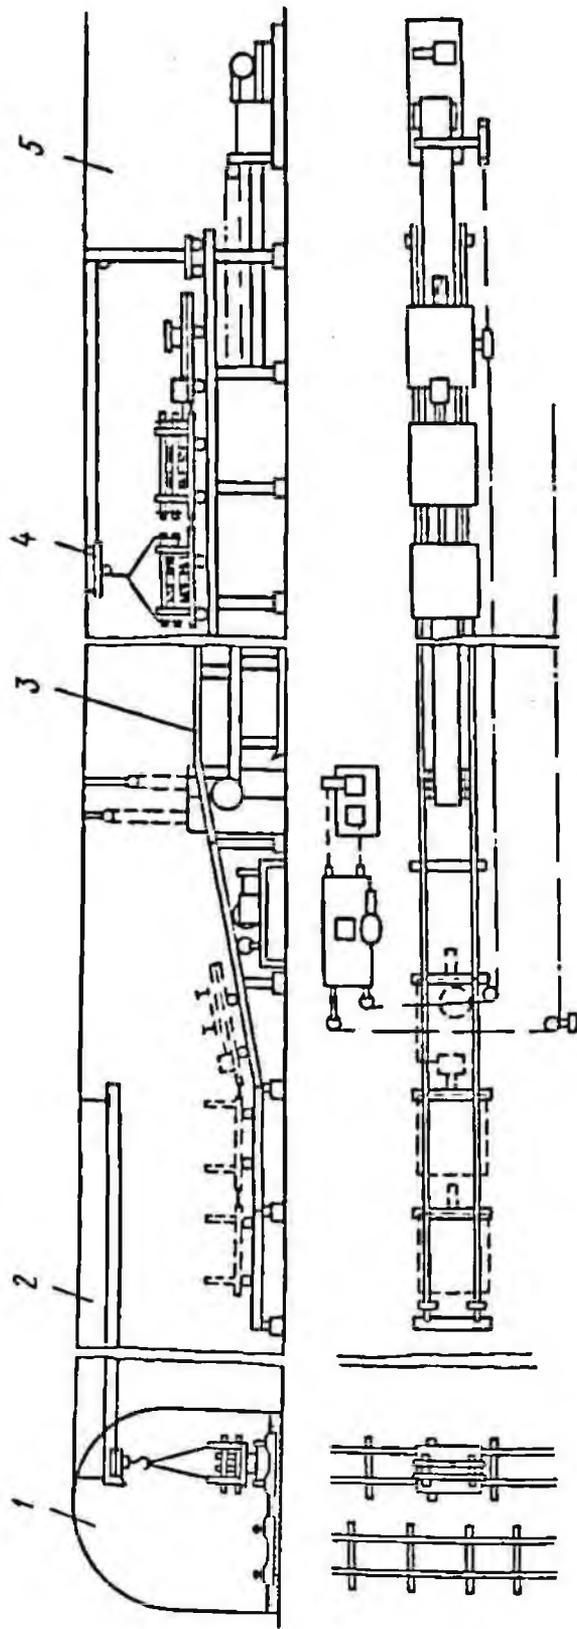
Комплекс транспортный конвейерный КТК для выемочного конвейерного штрака:
